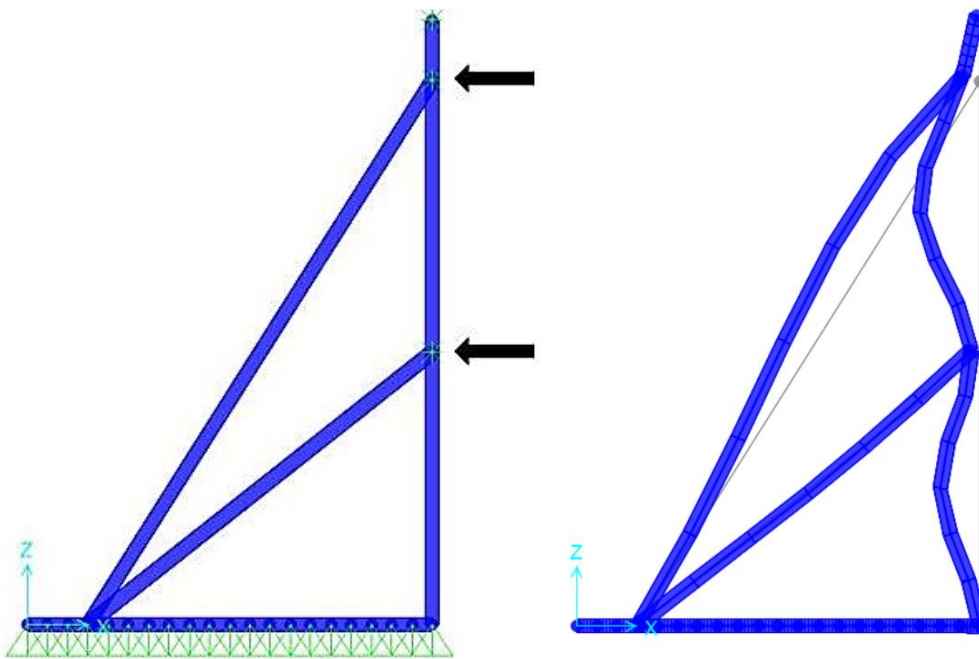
Deflexiones generadas en el apuntalamiento tipo zapata mural
